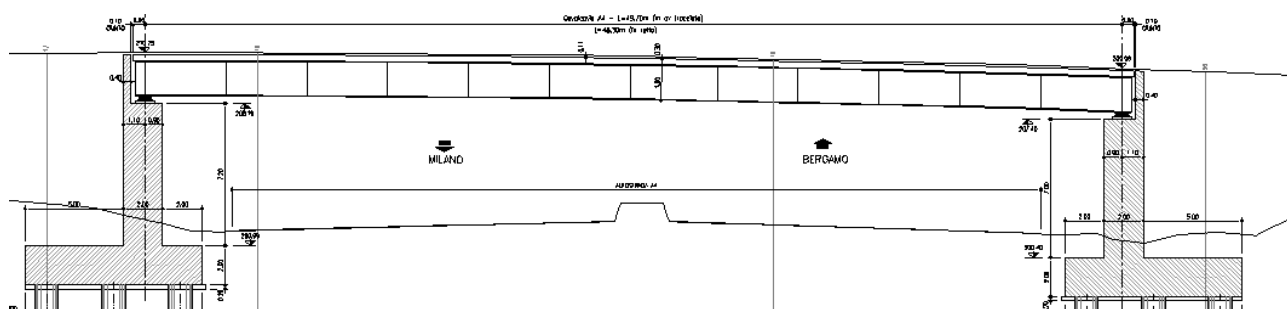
prospetto del nuovo cavalcavia autostradale
